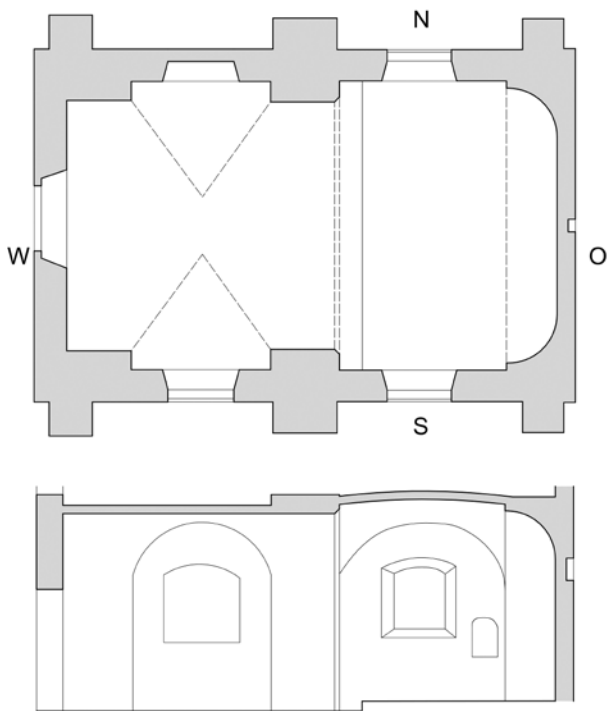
a. Grundriss der Kapelle, b. Längsschnitt ohne Dachstuhl
